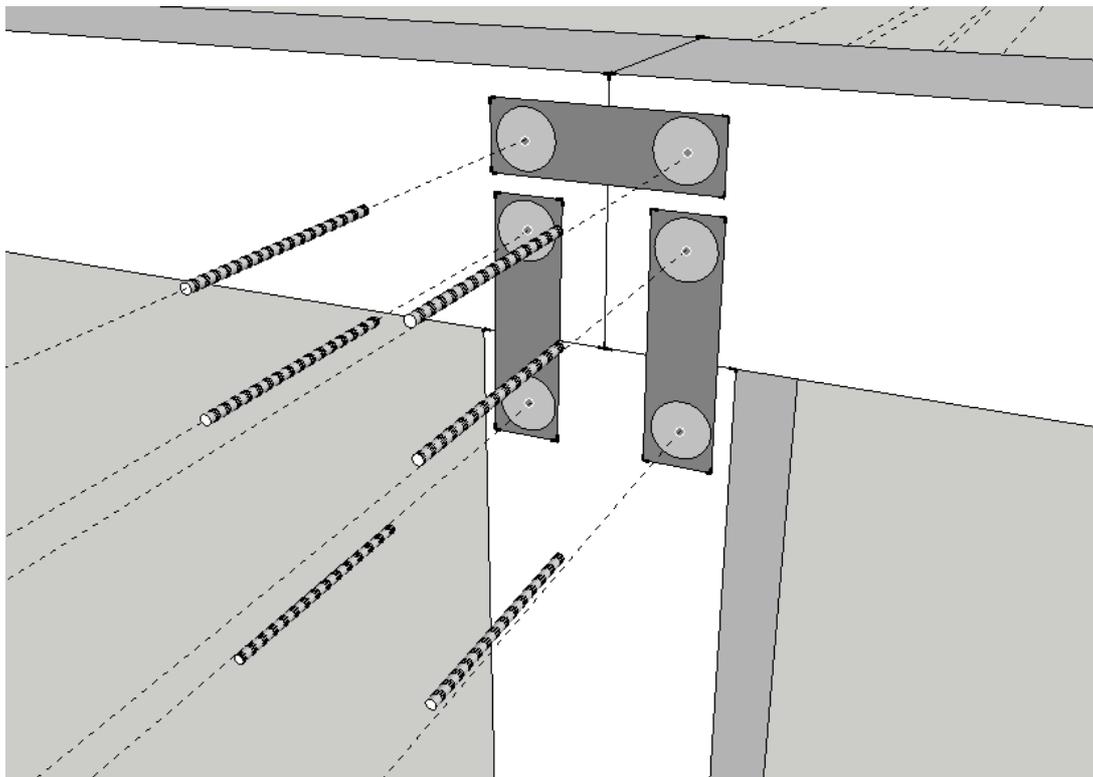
Fixation des fermes aux poteaux de soutènement intérieurs.
